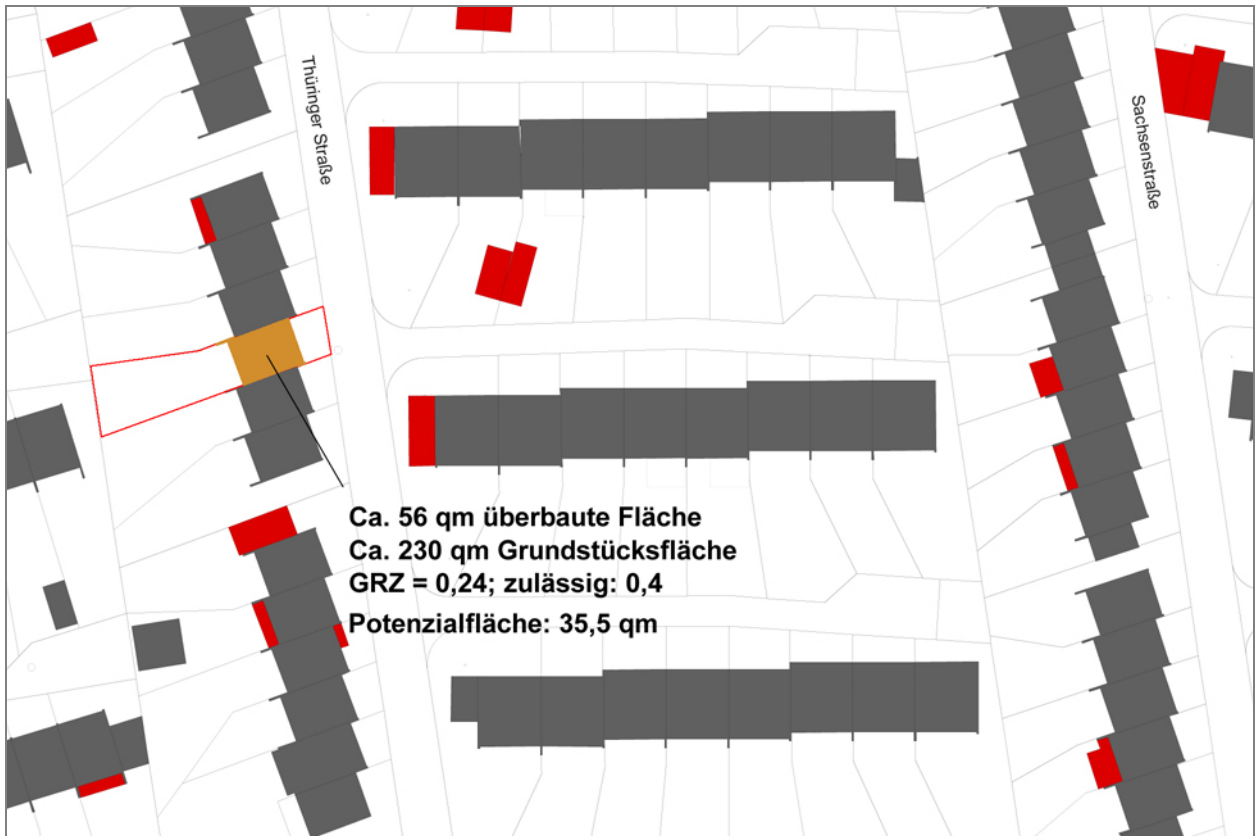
Ausschnitt der Reihenhausbauung, genordet, M 1:1.000; die nachträglichen Anbauten sind rot gekennzeichnet. Die Berechnung der potenziell zu erweiternden Fläche erfolgt auf Grundlage des Entwurfs für den neu zu erstellenden Bebauungsplan. Dieser gibt eine maximale GRZ von 0,4 vor.
